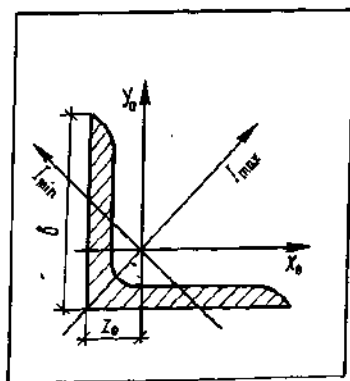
Расчетная схема уголка (пример 10.2)
